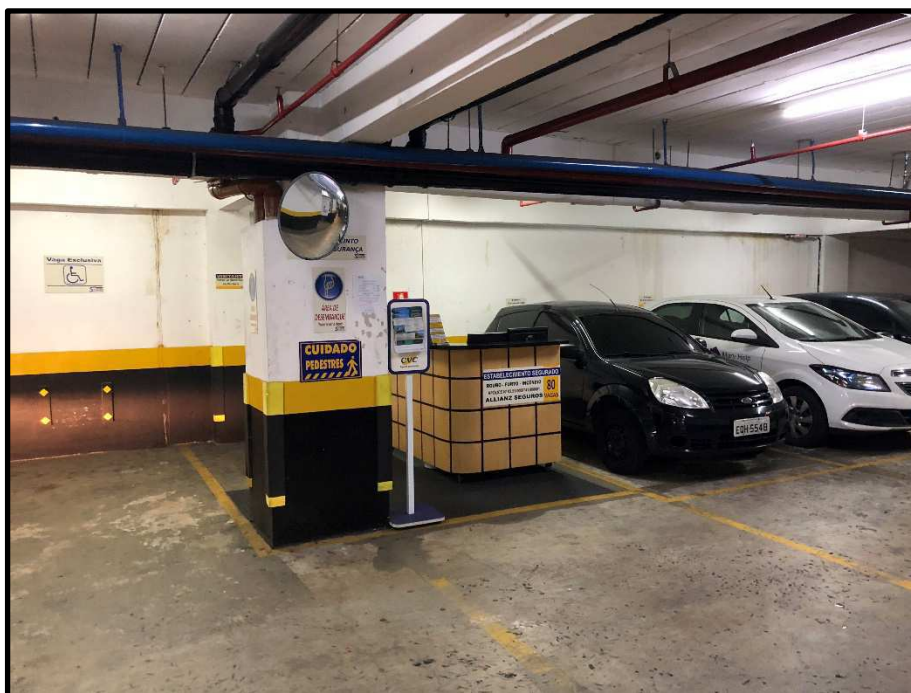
1º subsolo – vagas de garagem – Vista 1
